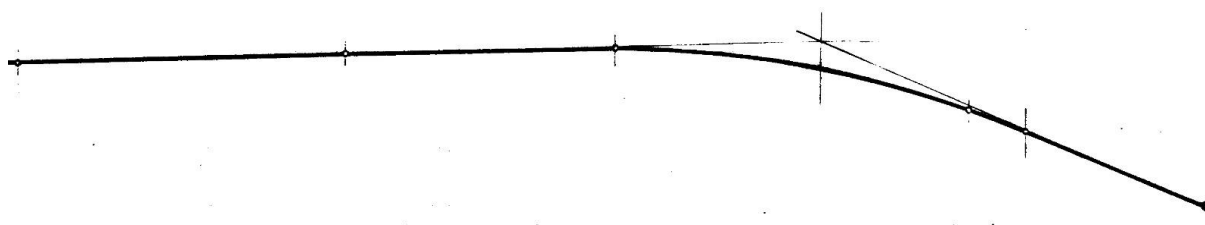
Traçado longitudinal de uma secção da linha A que inclui o troço 1
